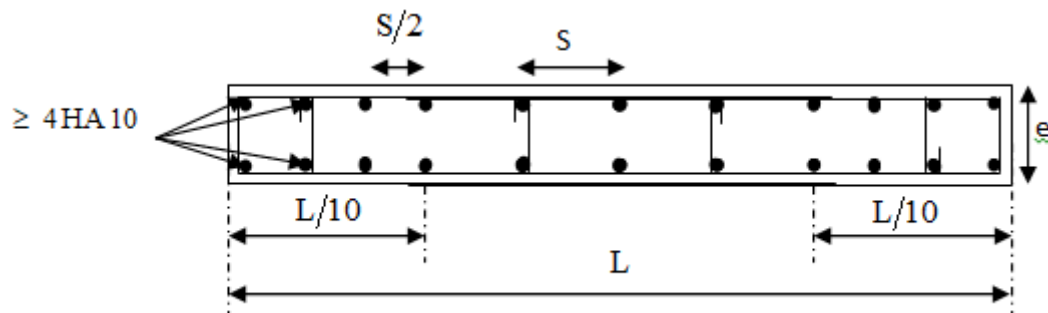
Disposition des armatures verticales dans les voiles.
